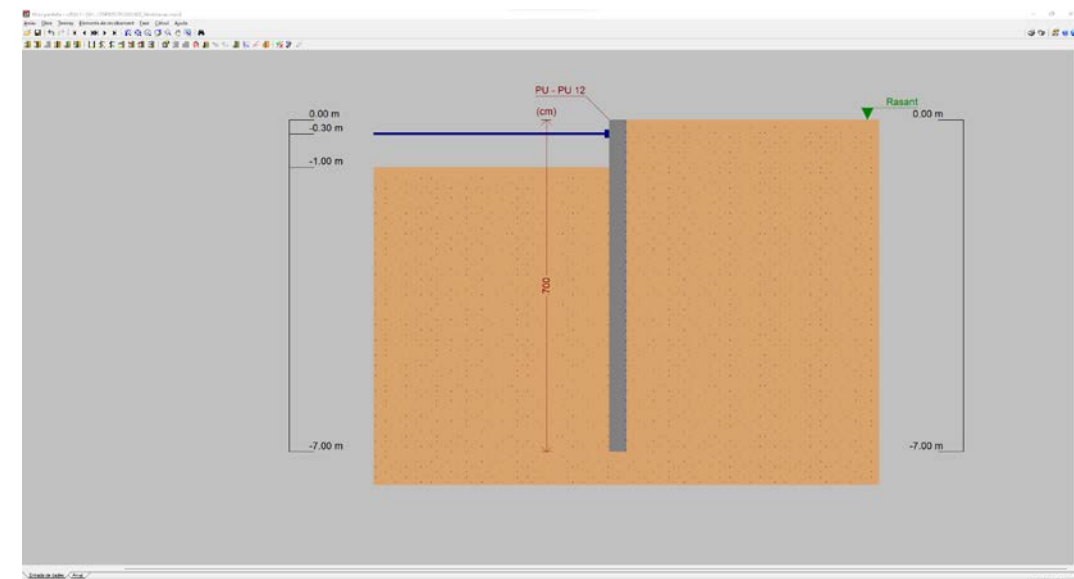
Fase de excavación y arriostramiento – Intradós
